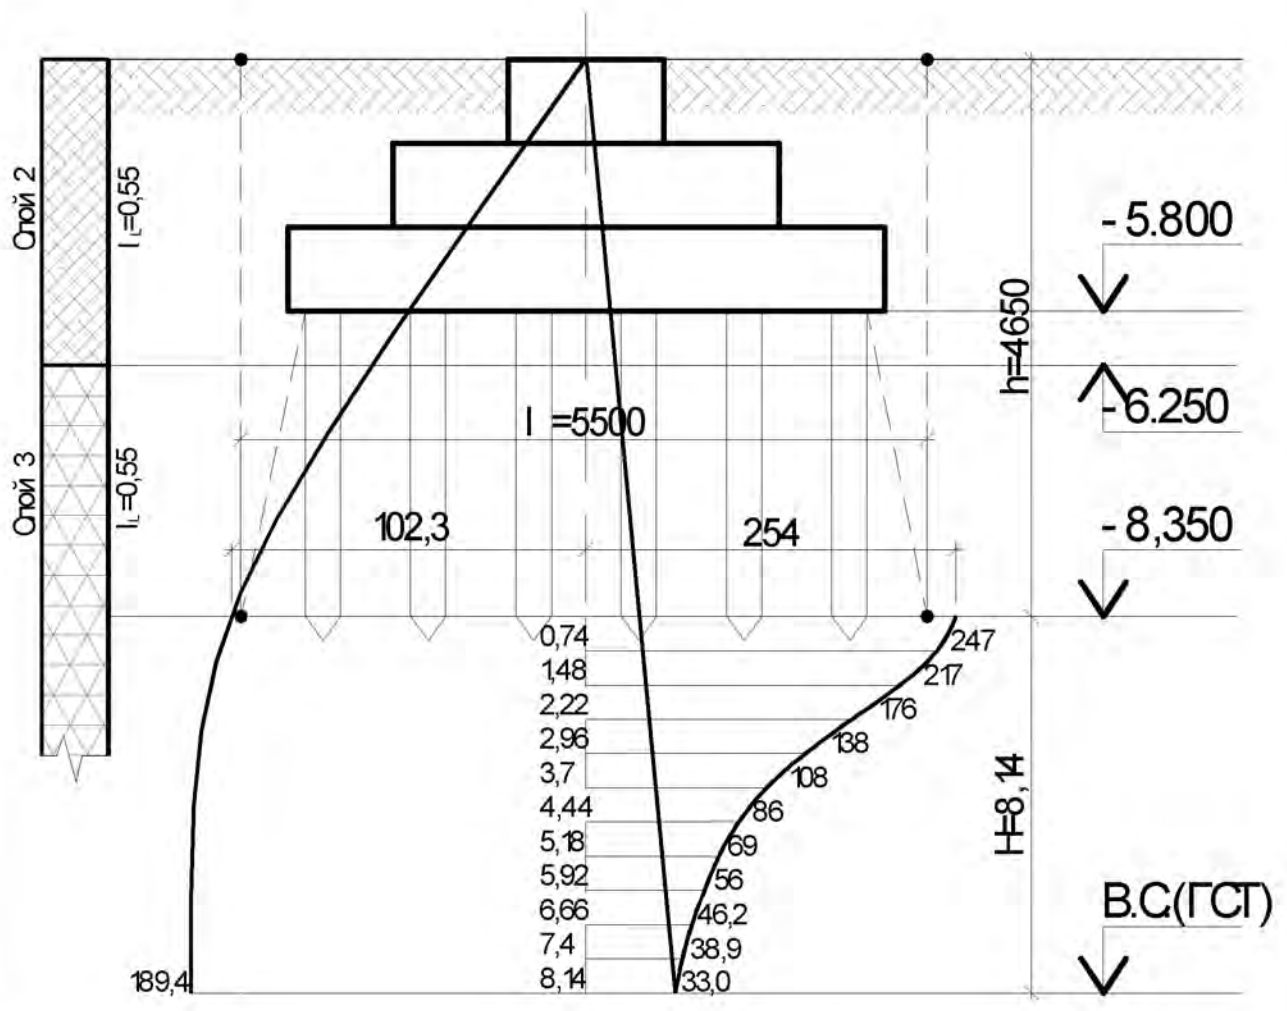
Схема к расчёту осадки свайного фундамента.
